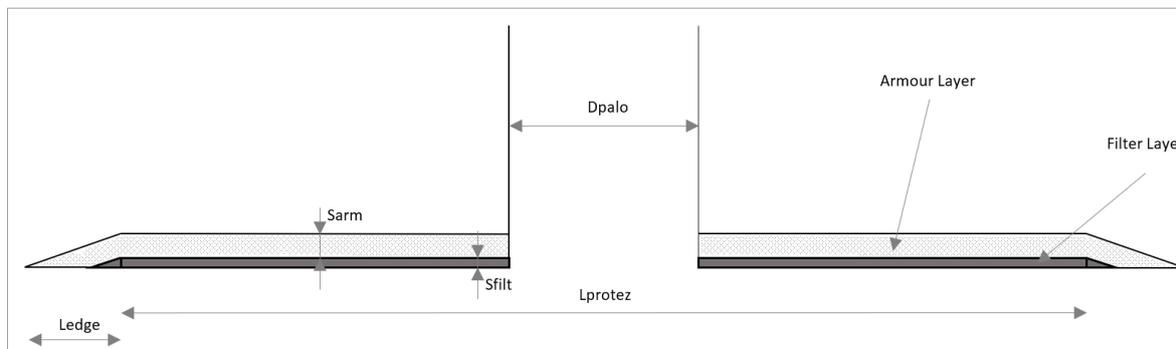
Disposizione caratteristica della protezione dell'area di fondazione.
